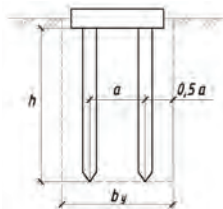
Схема к расчету осадки фундамента согласно СП 24.13330.2011
